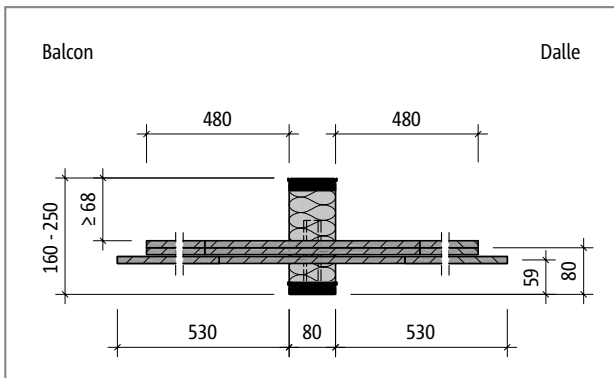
Schöck Isokorb® T Type H-VV2-NN1 : Coupe du produit
